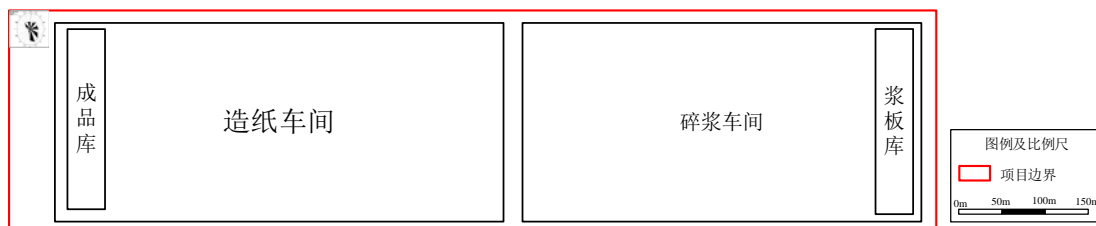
9.8 万吨激光打印纸项目平面布置图
